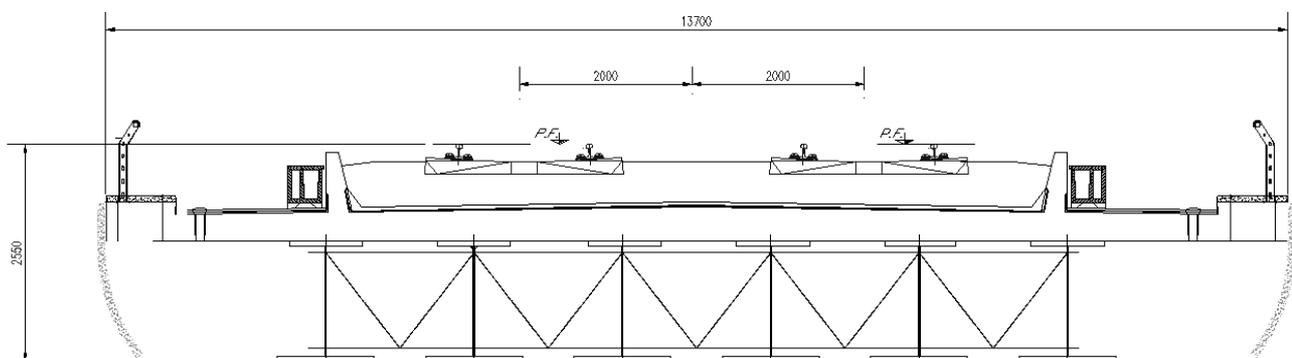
Impalcato in acciaio - cls L = 32 m: sezione trasversale
